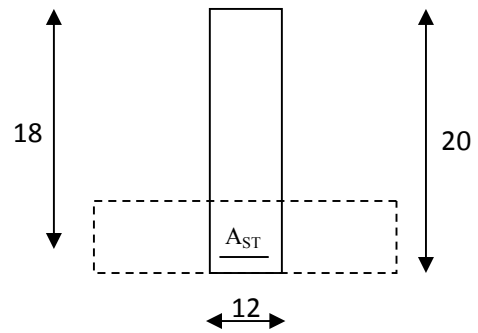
7 section de calcul de la poutrelle aux appuis
